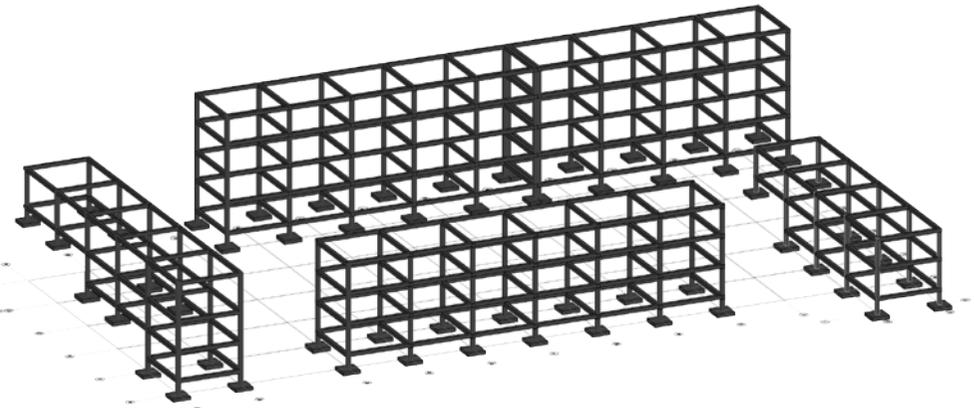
A continuación se colocan las vigas de hormigón armado de 0,30 x 0,25 m.
